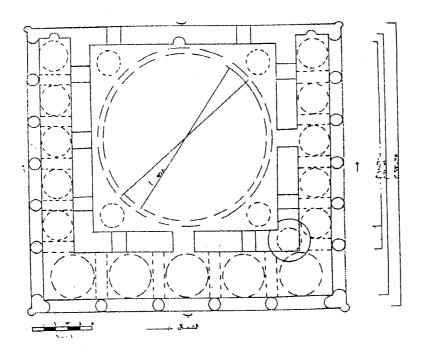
مسقط أفقى لمسجد الشيخ أبكر في مدينة التحيتة (عن الحداد) .
